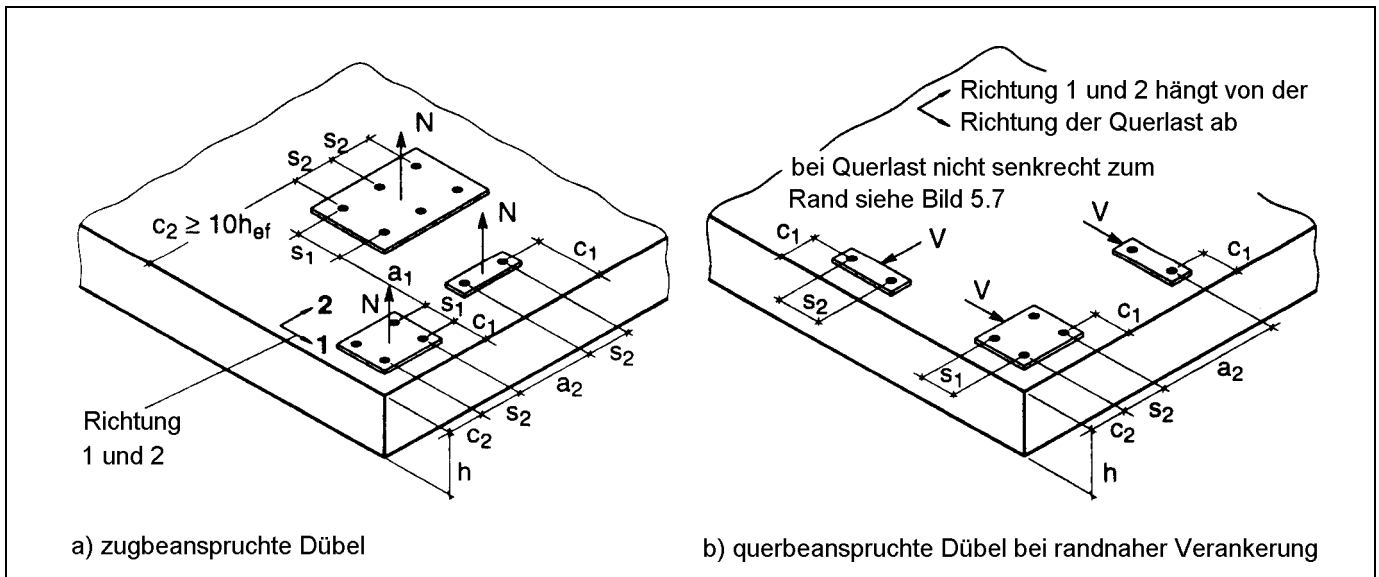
Betonbauteil, Dübelsachs- und -randabstände
